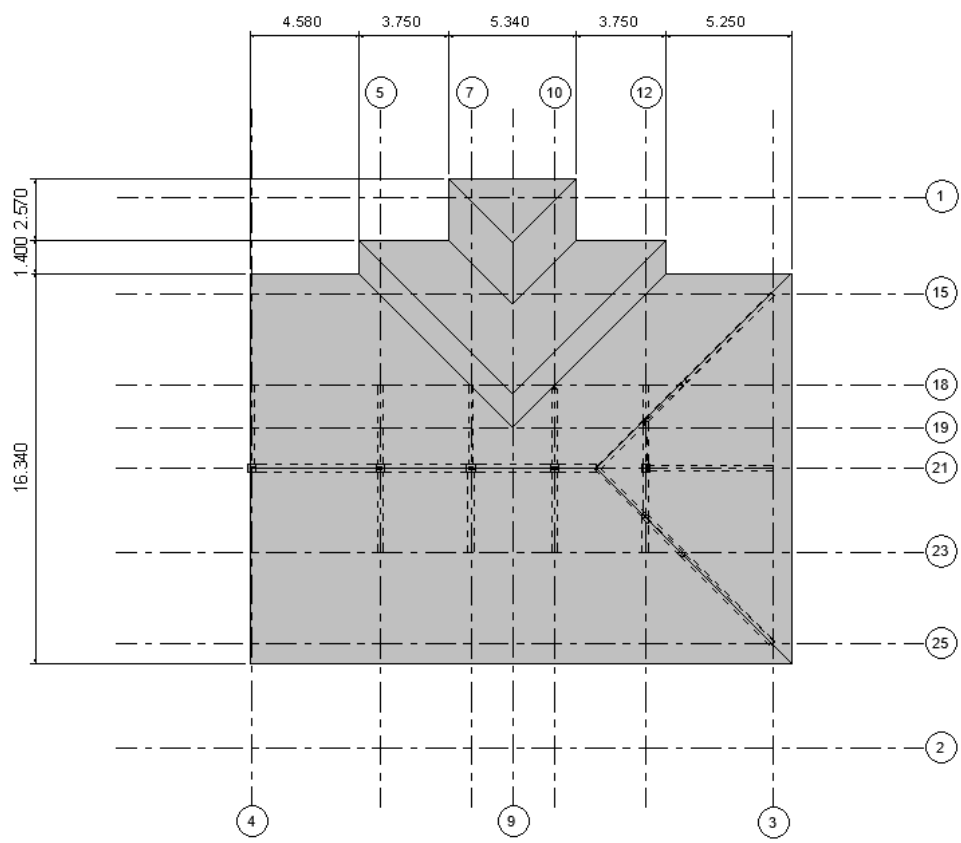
Planta estrutural da cobertura da solução estrutural 1 (Revit).
